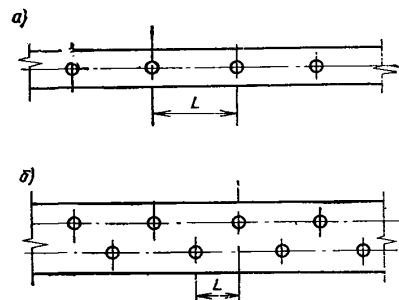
Расположение свай в свайных фундаментах под кирпичные и крупноблочные стены
